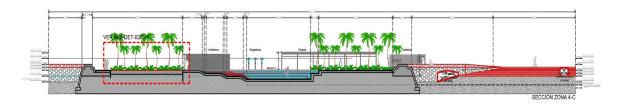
Corte a lo largo del proyecto en el polígono 2. Construcción del Malecón Salina Cruz.
